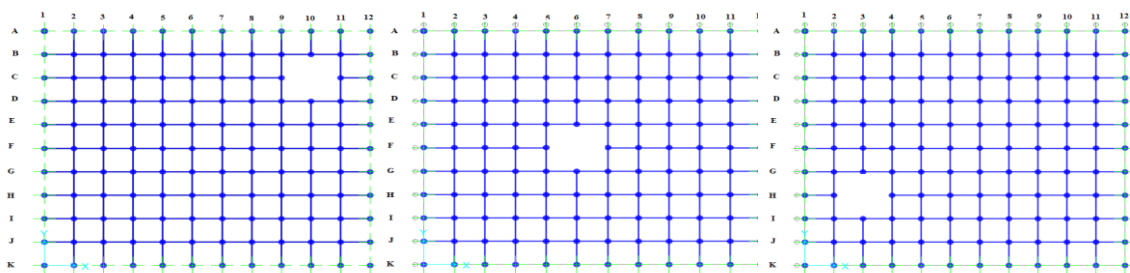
Aberturas nas lajes em 3 situações: a) no canto; b) no centro e c) na lateral.
